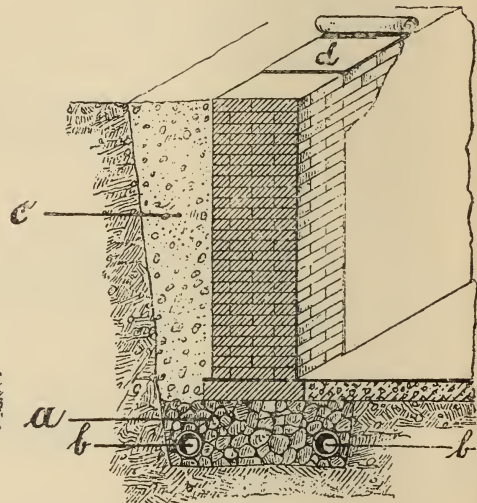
Fondation avec drainage spécial (d'après Emmerich).
